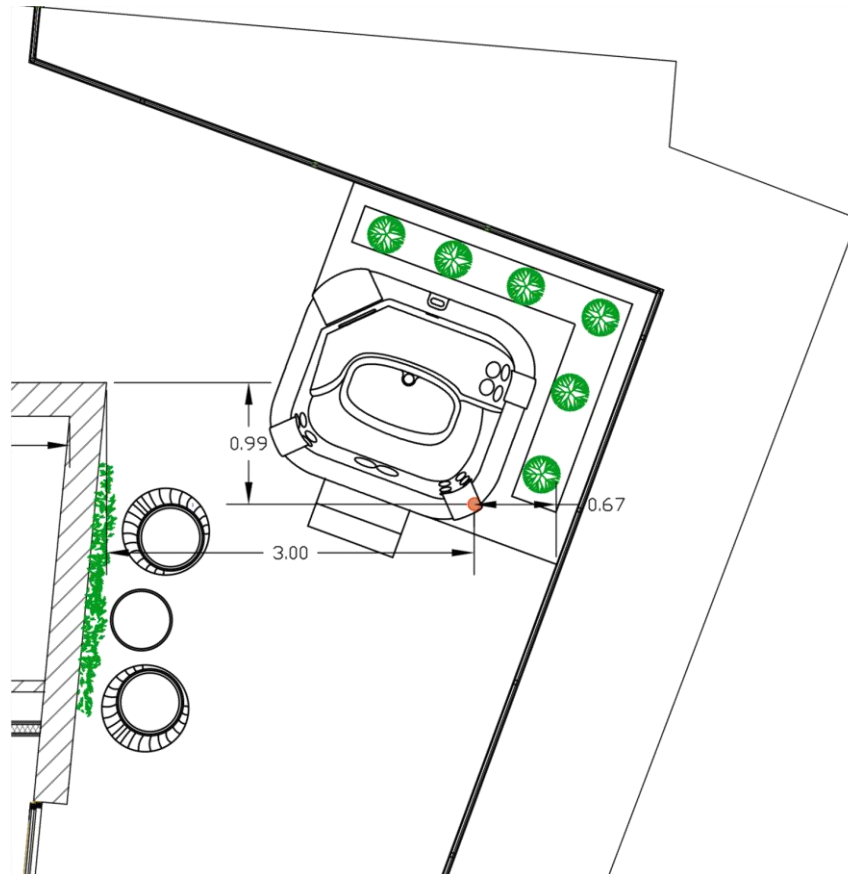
Pormenor Planta Zona de jacuzzi. Fonte: autora
